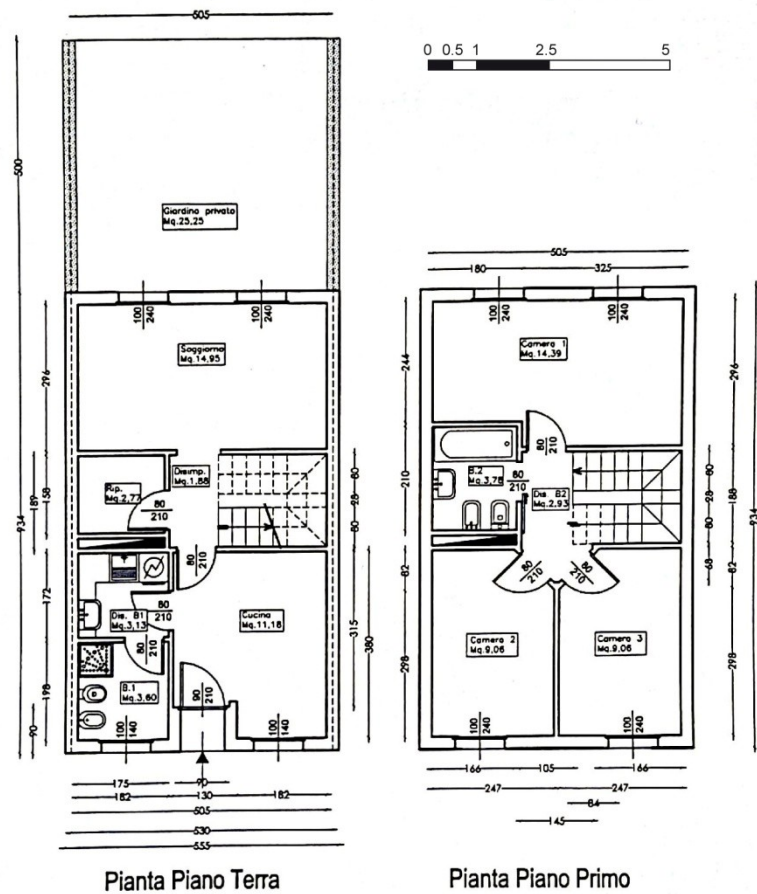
Planimetria del progetto definitivo del caso di Besana Brianza
